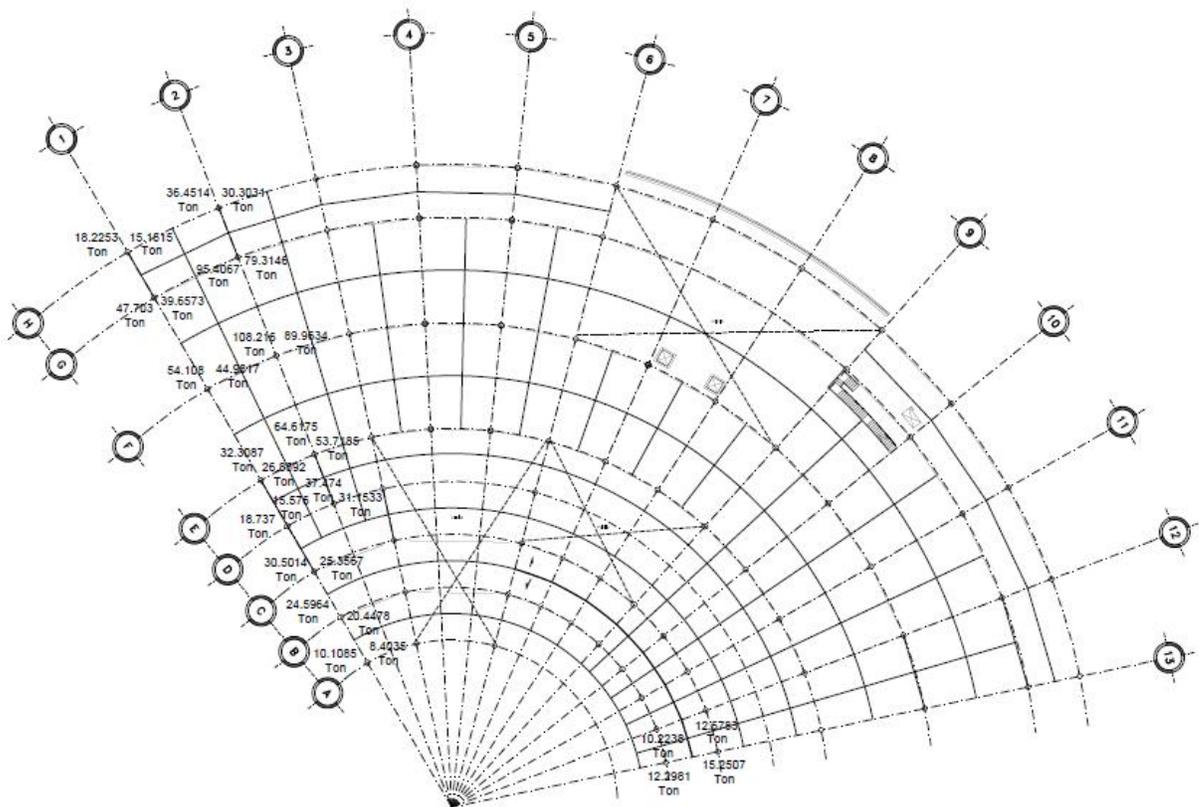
Bajada de cargas columnas. Fuente: el autor
